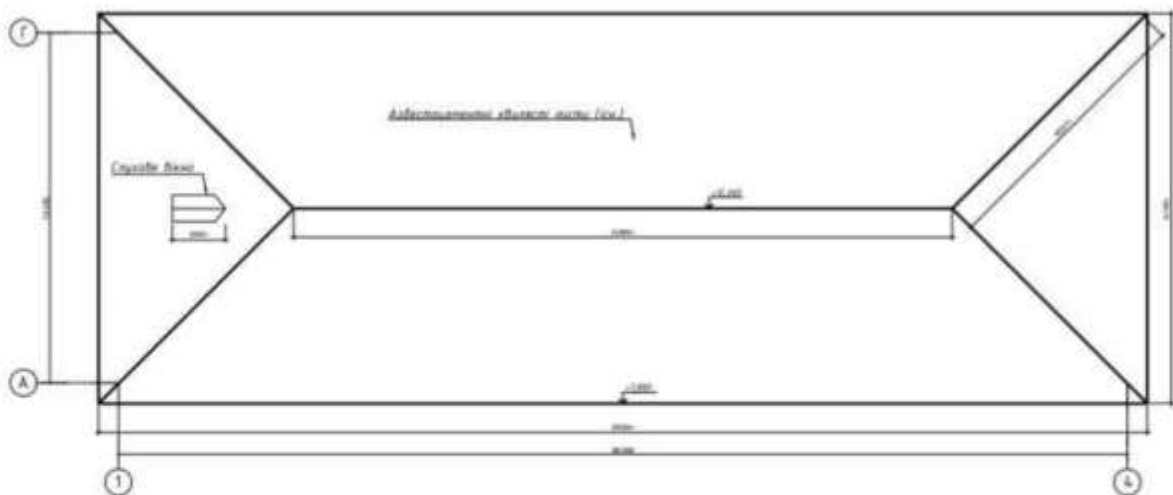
План покрівлі обстежуваної будівлі
